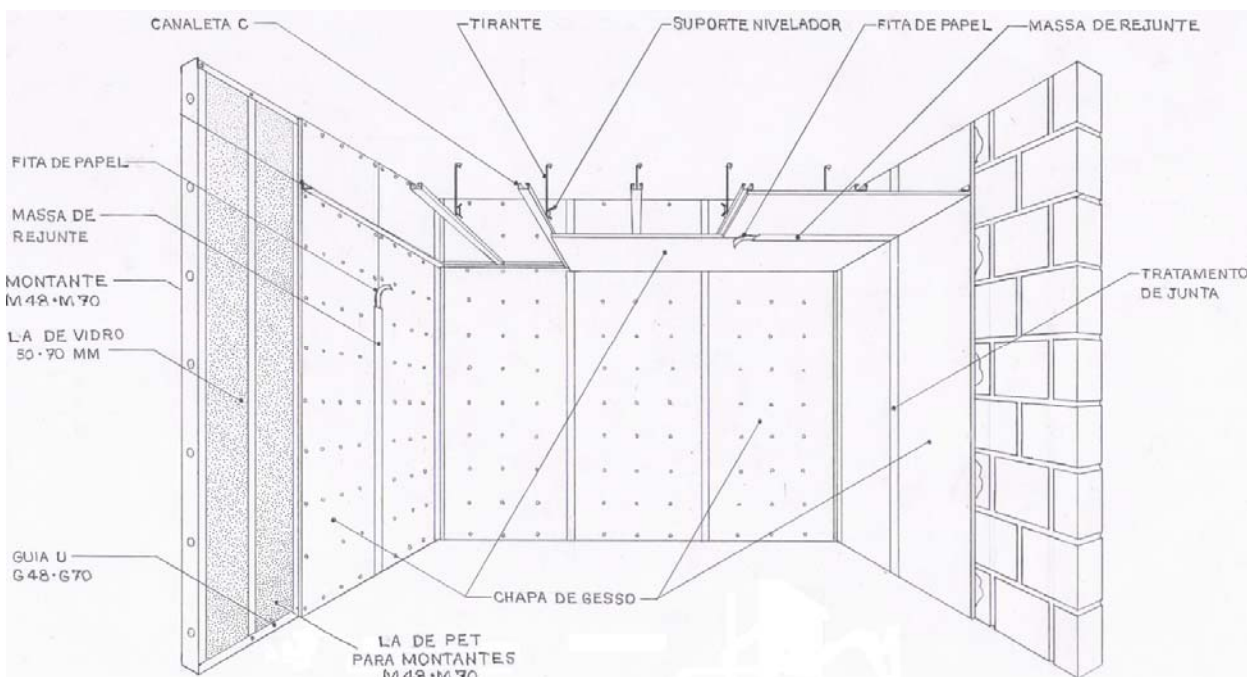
Ilustração do sistema construtivo em chapas de gesso para drywall
